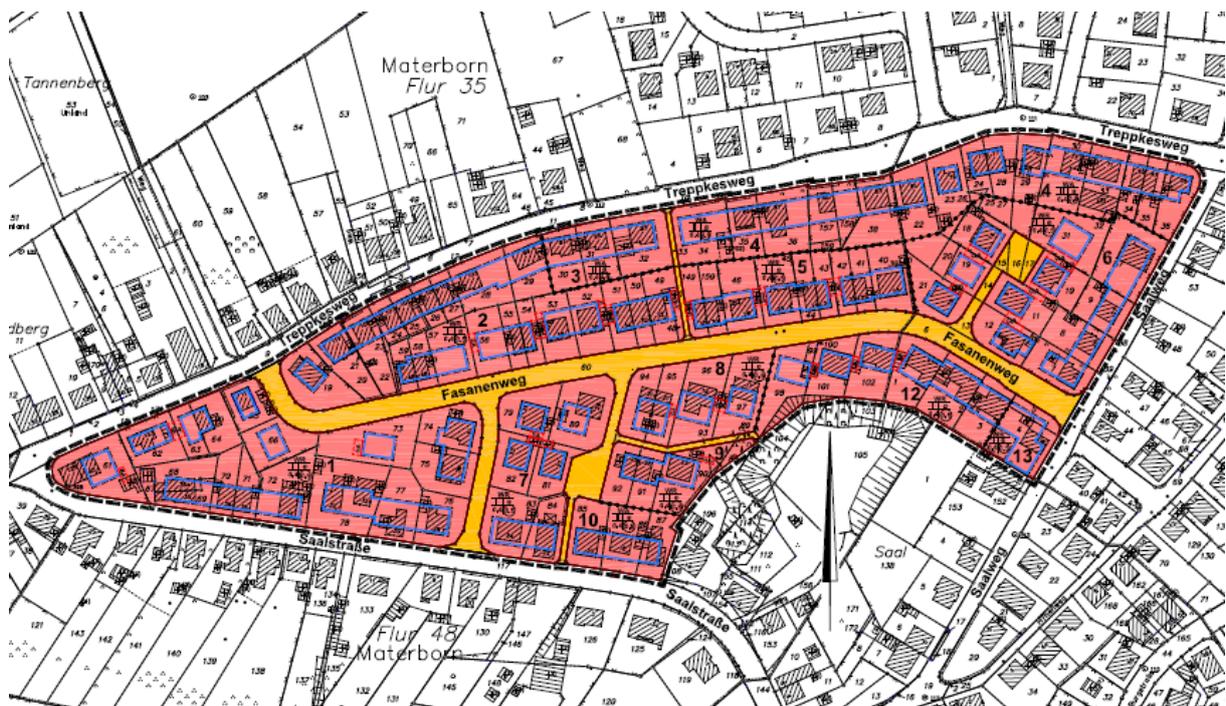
Festsetzungen des Bebauungsplans 4-020-0, unmaßstäblich
